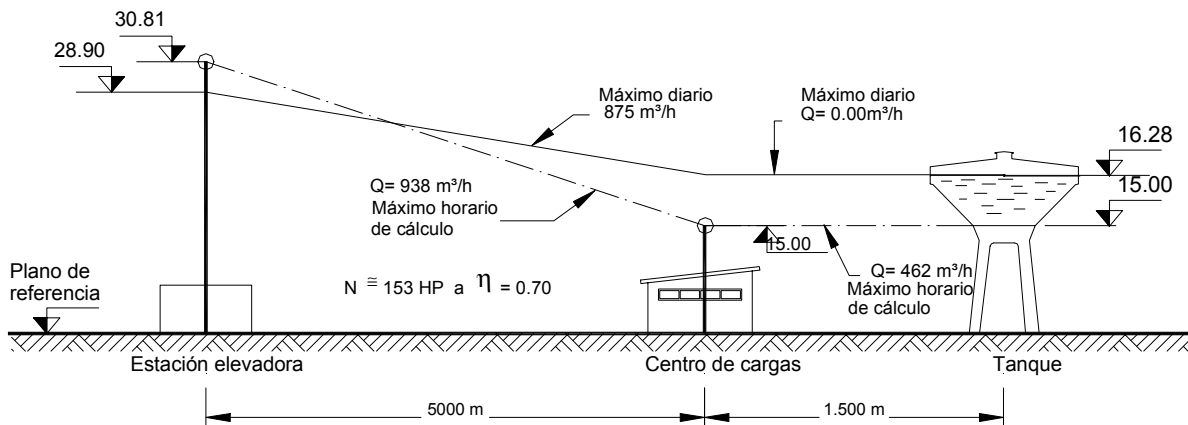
Baricentro de las cargas entre la estación elevadora y el tanque
